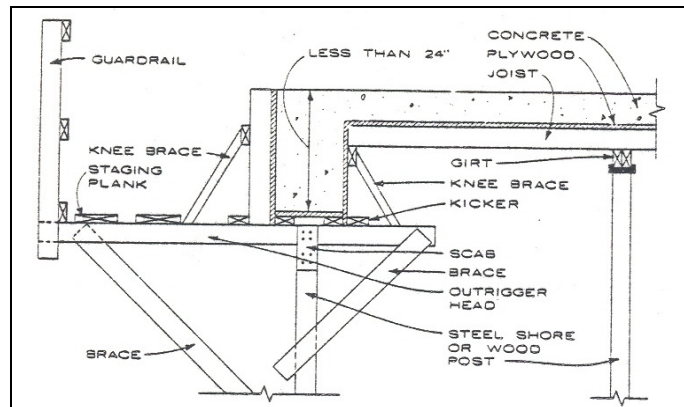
"Encofrado para vigas y losas de hormigón (Ramsey, 1981) [12]"
